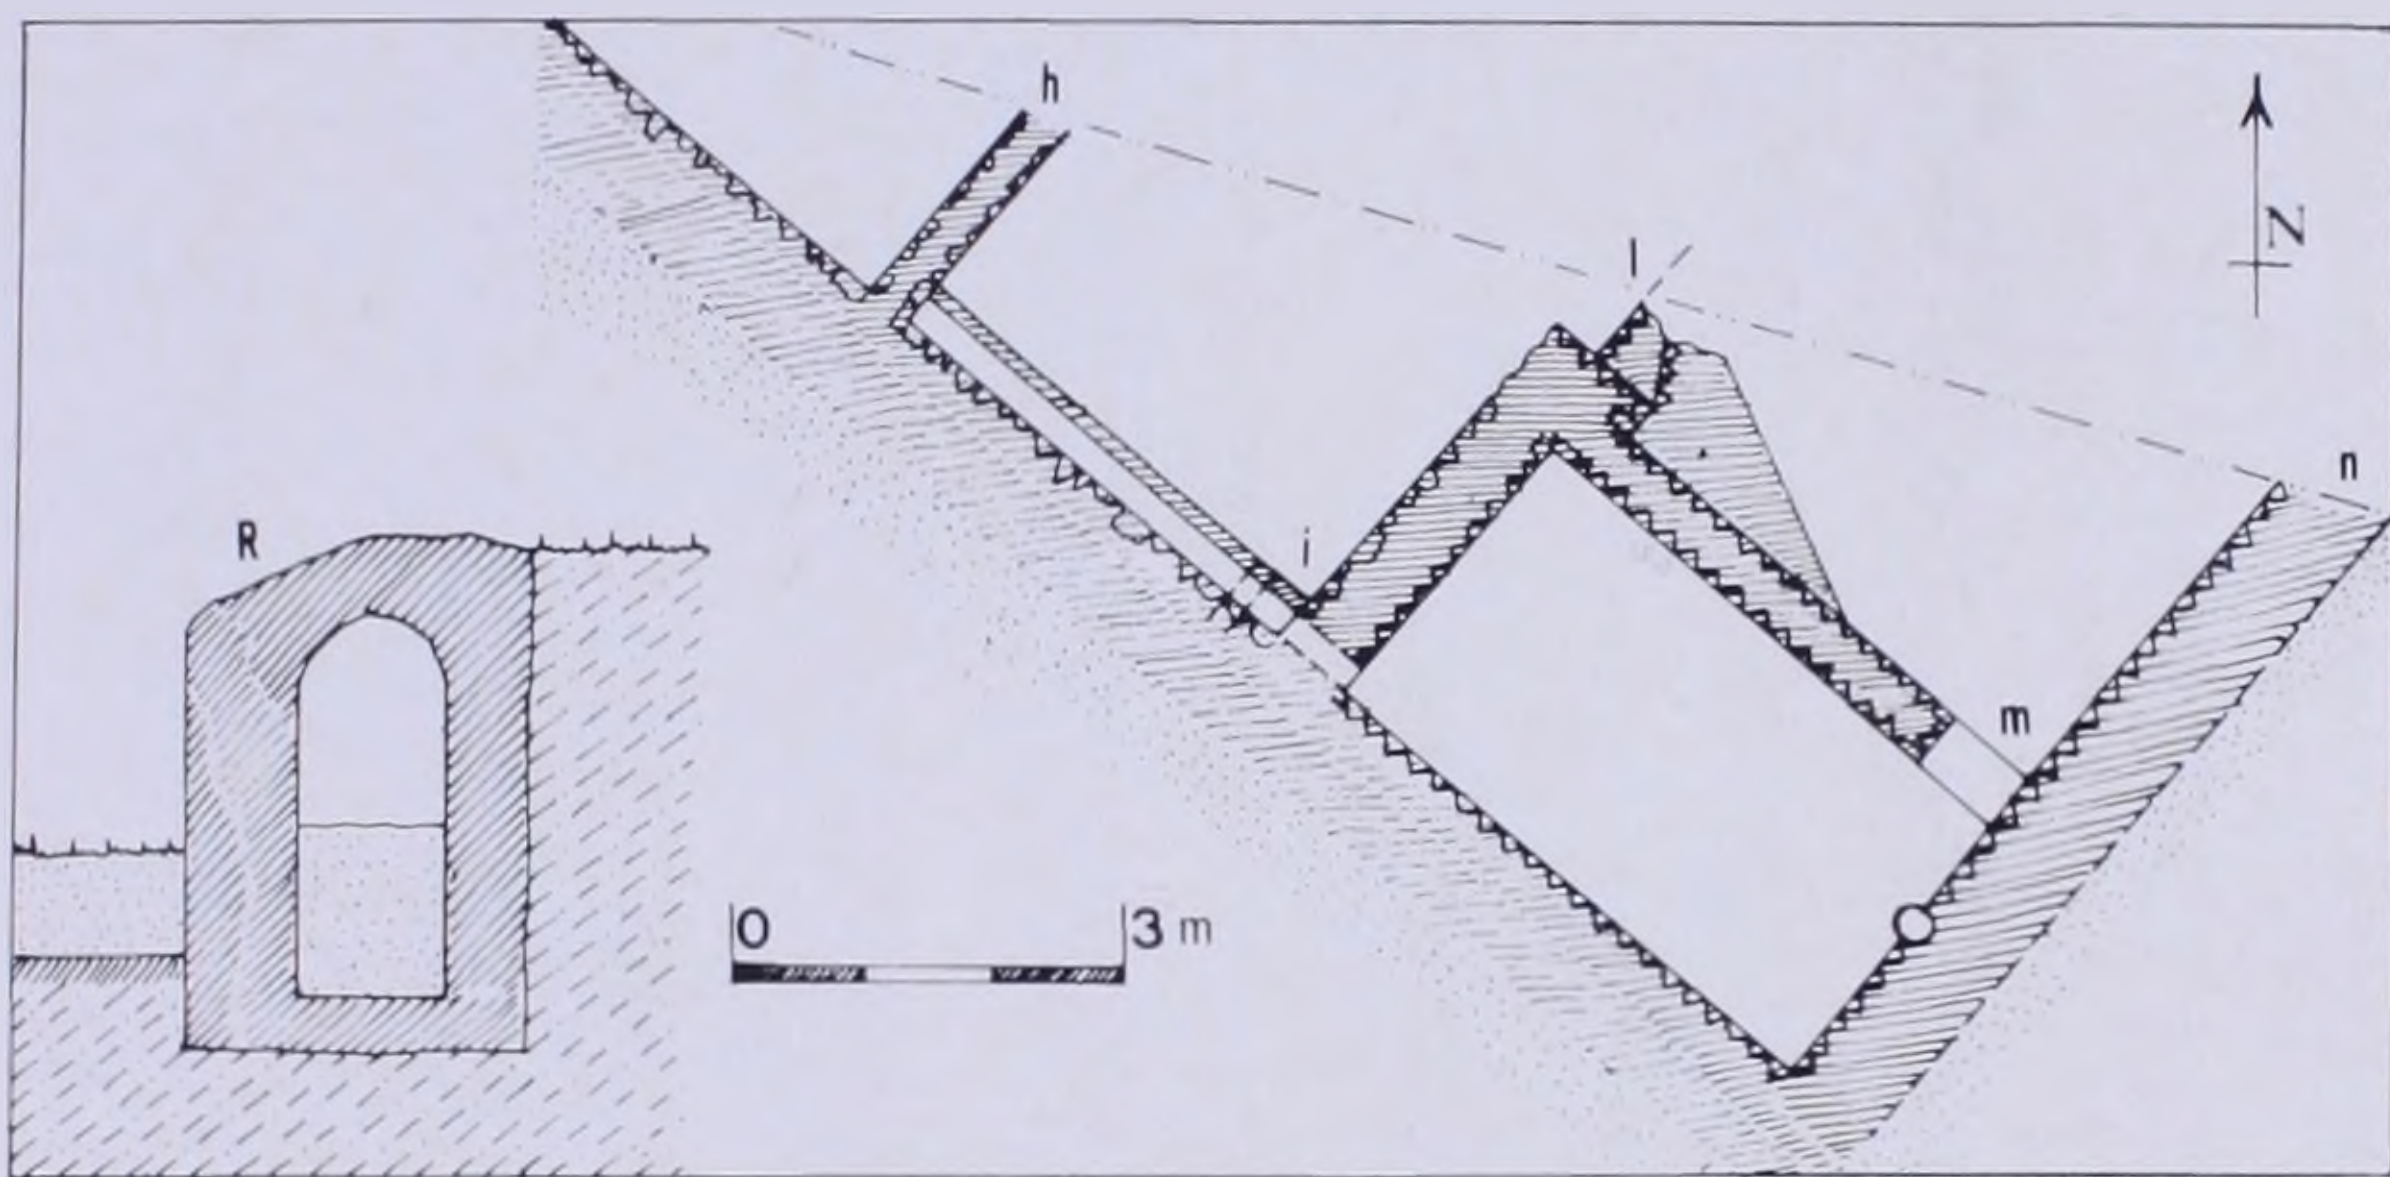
Villa detta di Opimiano, particolari: sezione del collettore R e pianta delle strutture $h-n$.
